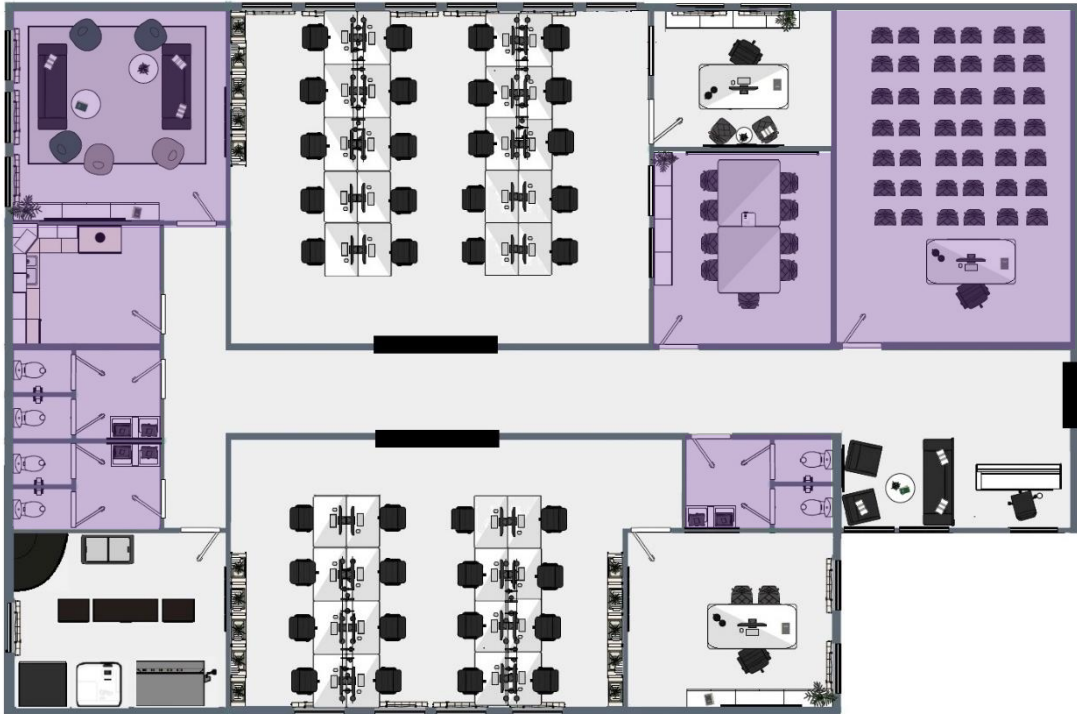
Conjunto de áreas de trabalho privativas destacadas em azul
